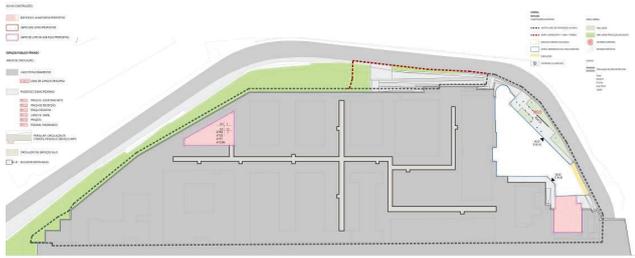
Planta Legal – Edificado e Arranjos Exteriores
